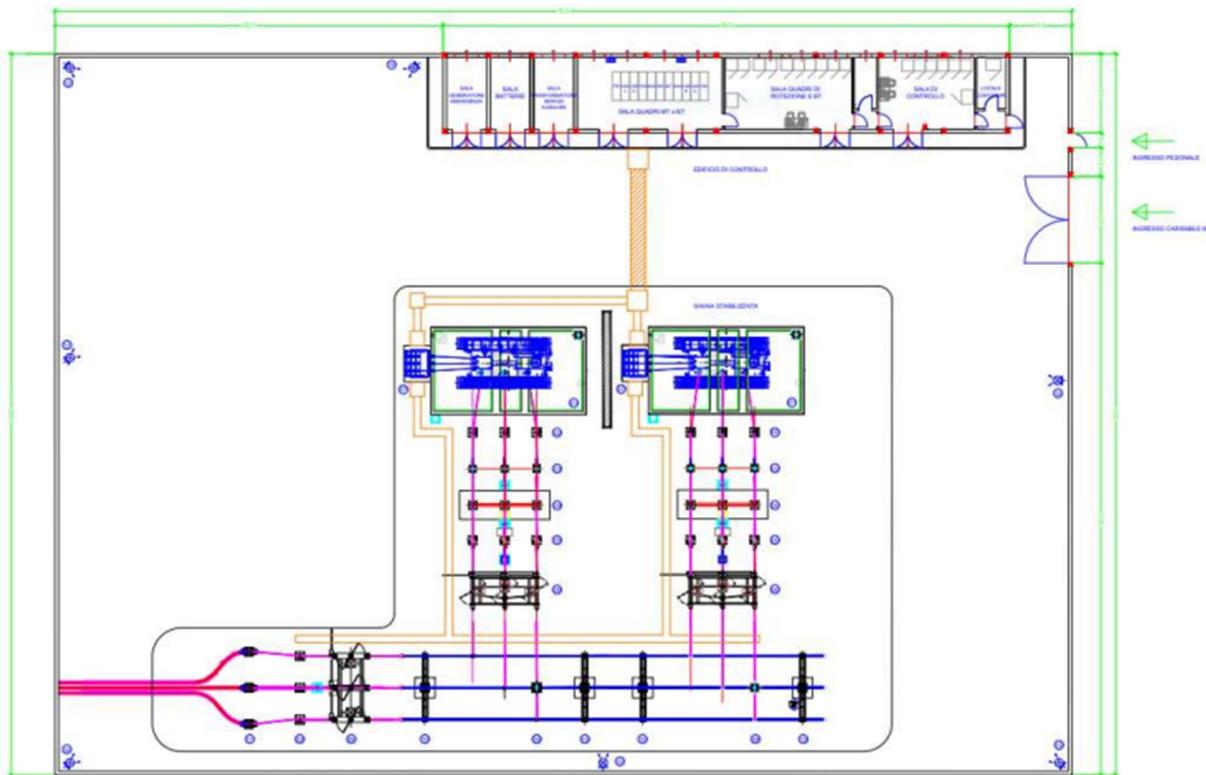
Layout sottostazione elettrica di trasformazione lato Utente (SSEU)
